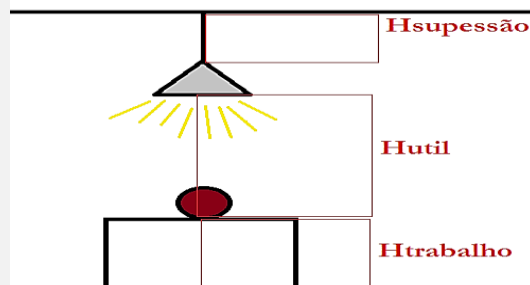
Plano de trabalho Fonte:[Autor]
